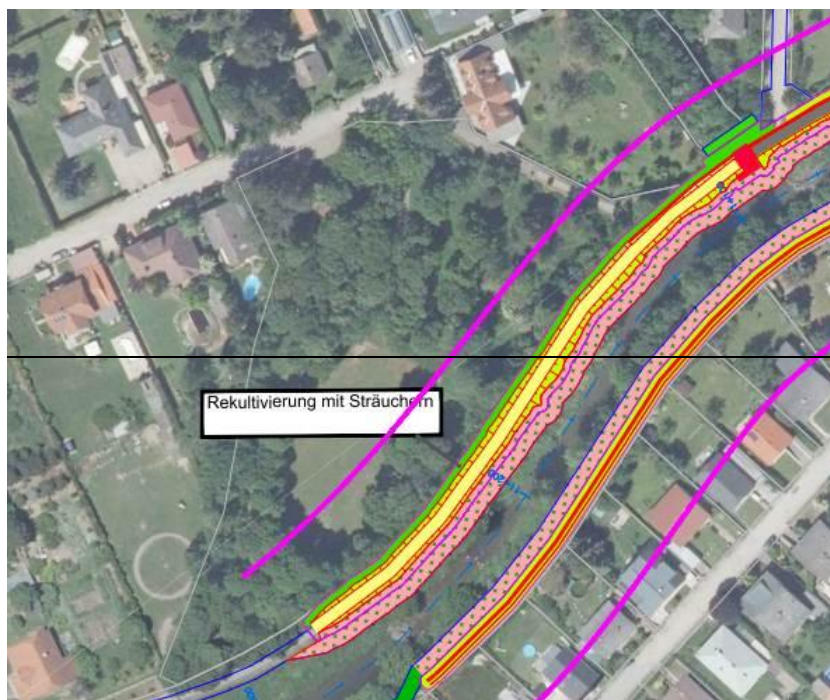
Radpark Trumau, Ausschnitt OLB Massnahmenplan Blatt 05 Trumau (Quelle: Einreichoperat, Einlage 247E)
